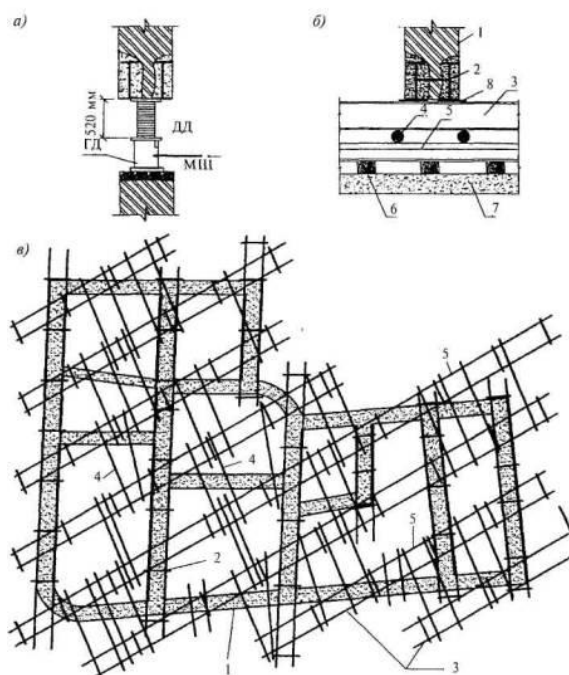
Схема установки здания на ходовые балки а - подъем здания гидравлическими домкратами; б - установка ходовых балок; в - план ходовых балок и обвязочной рамы для передвижения жилого дома; ГД - гидравлический домкрат; ДД - датчик давления; МШ - материальный шланг; 1 - перемещаемое здание; 2 - обвязочный пояс; 3 - ходовые балки; 4 - катучие опоры; 5 - рельсовый путь; 6 - шпалы; 7 - бетонная подготовка основания; 8 - связи для объединения обвязочных балок
